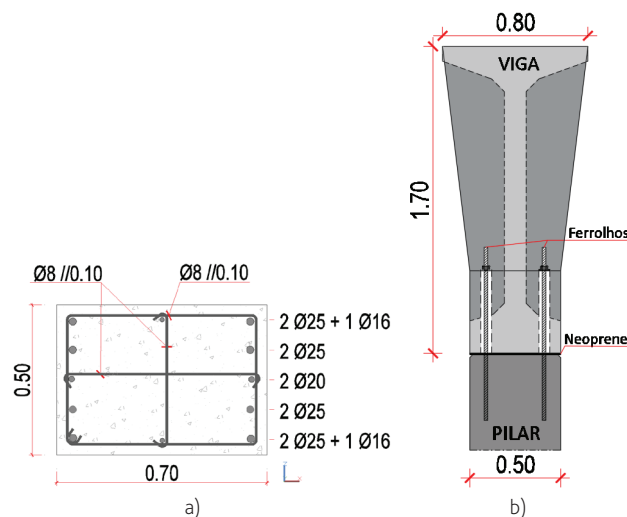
Detalhes da secção transversal dos pilares (a) e vigas longitudinais (b)
